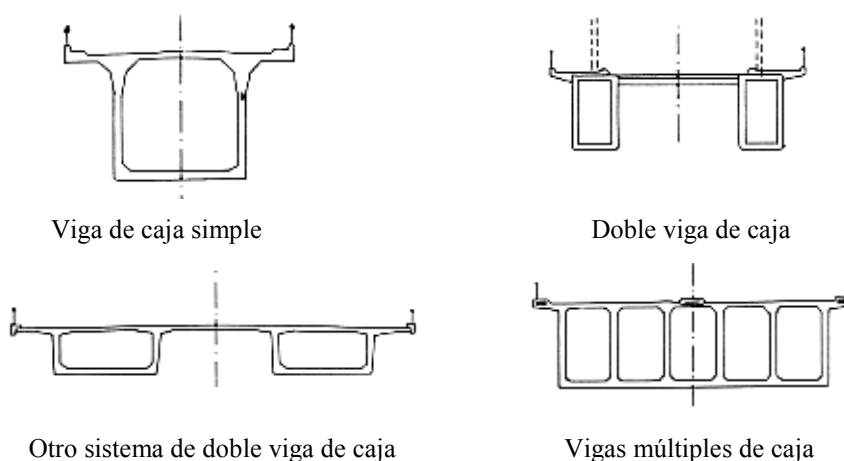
Tipos de vigas principales de acero más comunes en la cubierta.
